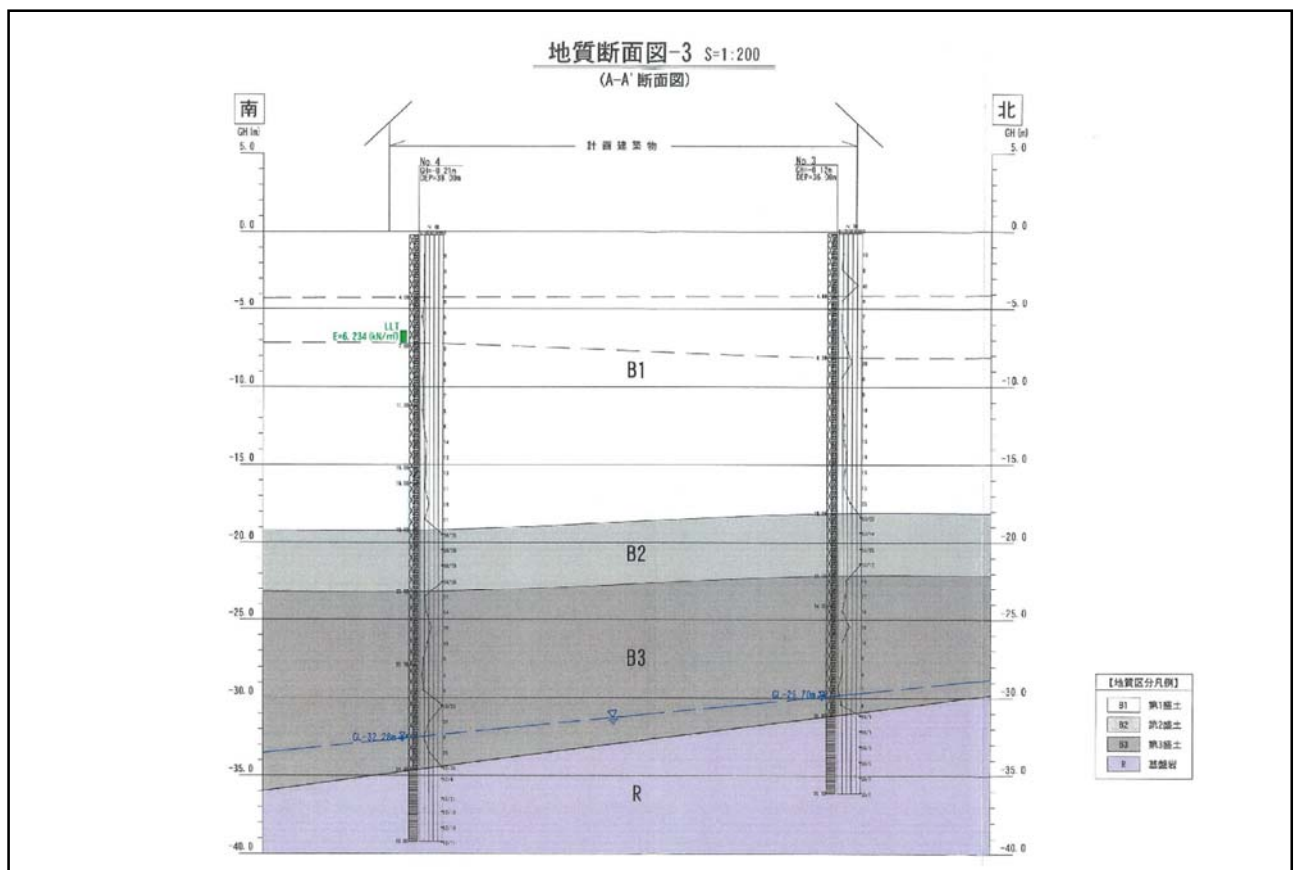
地質断面図(Ⅱ-Ⅱ'断面)
